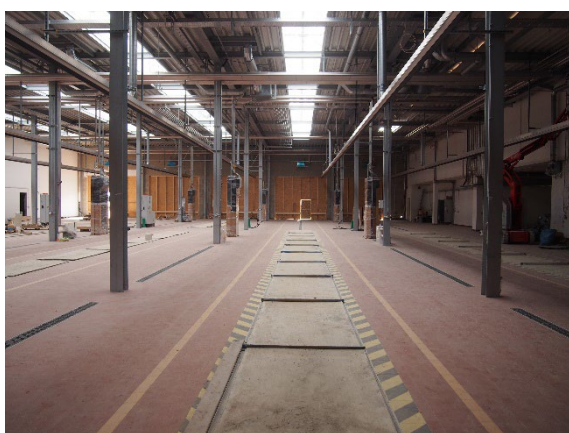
Betriebshof Werftstraße – links neue Arbeitsstände – rechts bestehende Abstellhalle
